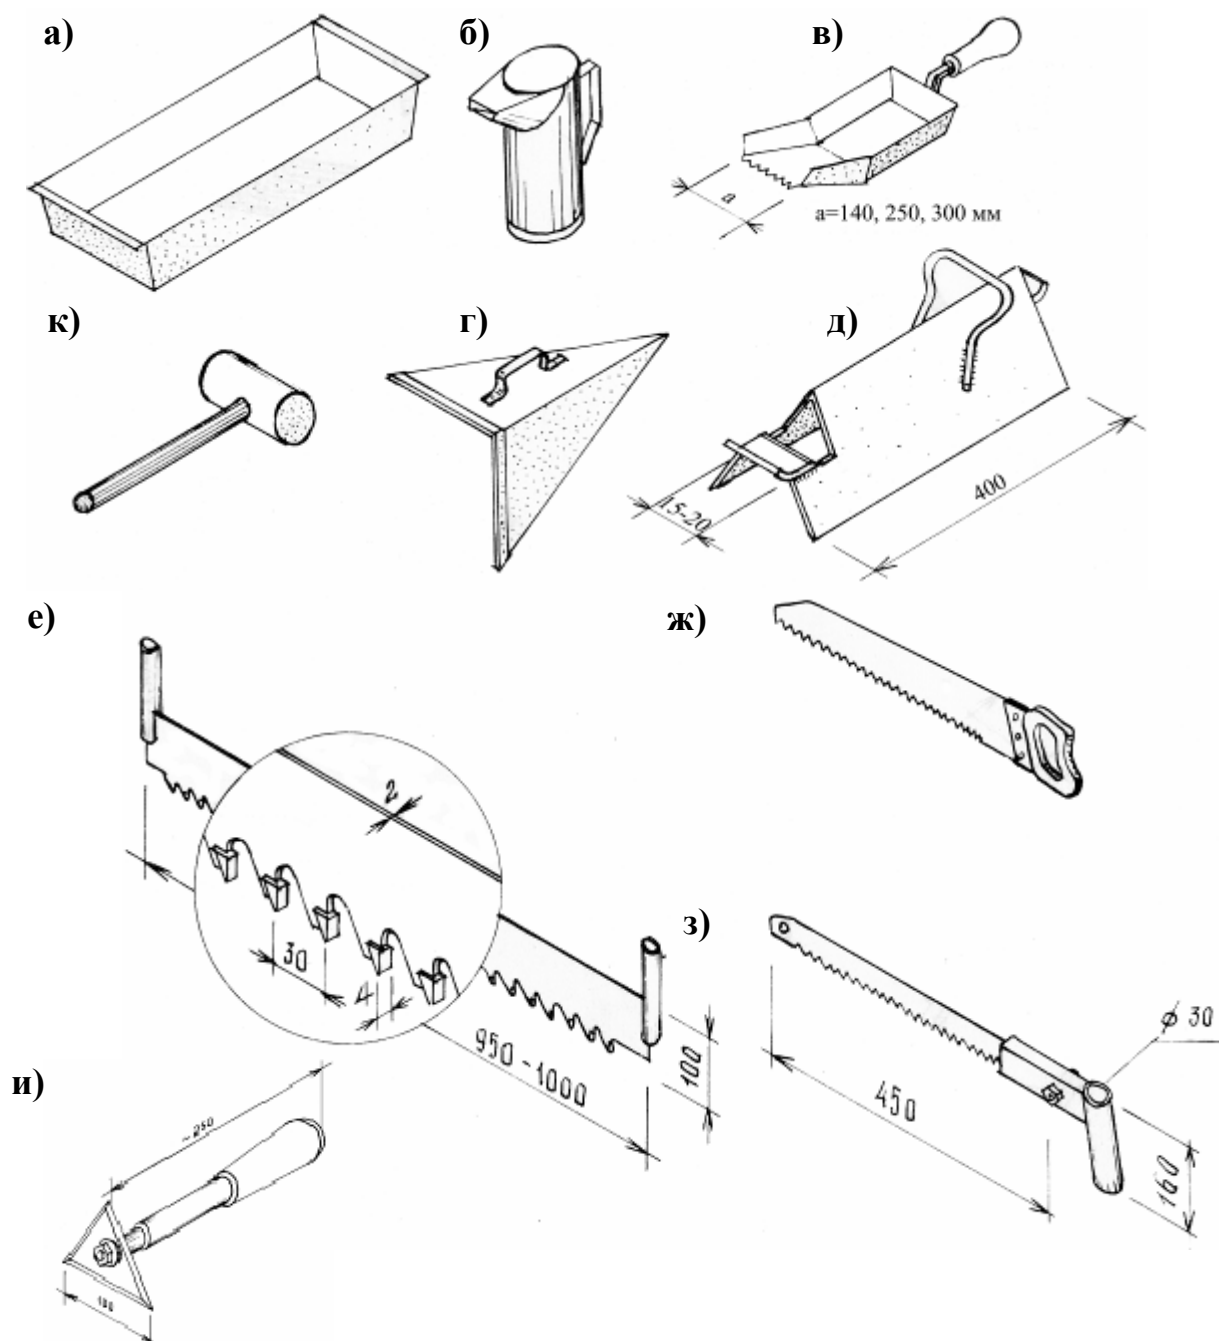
Инструменты и приспособления для кладки стен
